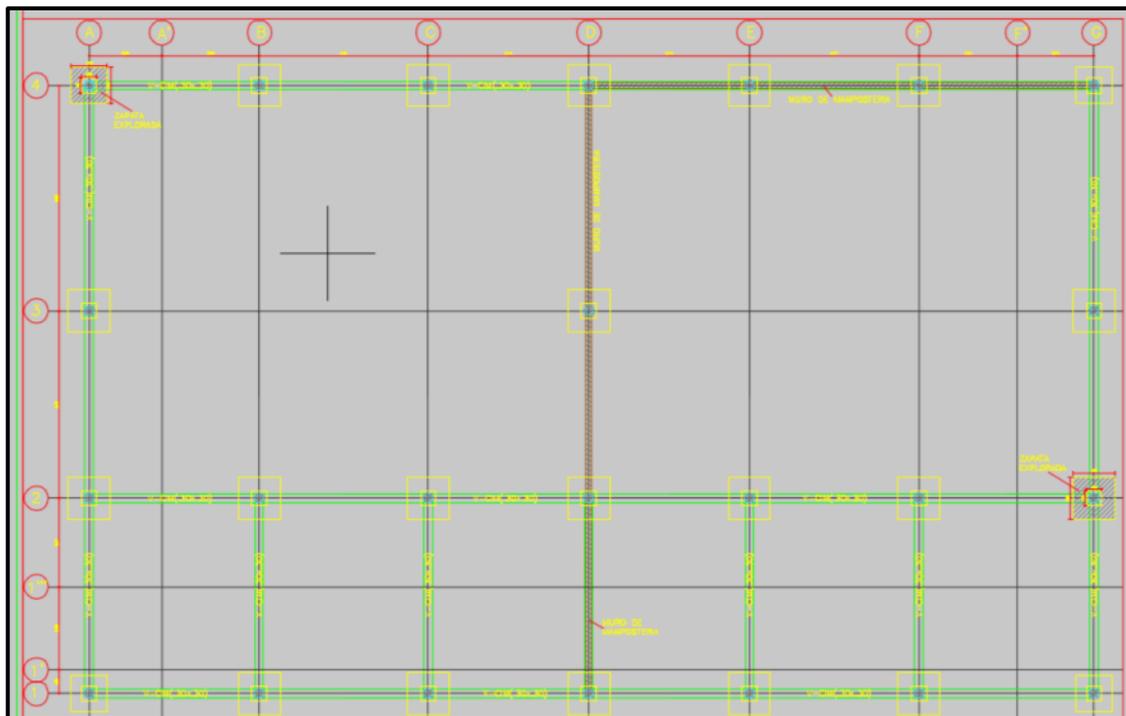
Planta de cimentación – Estructura No. 1 Bloque Automotriz
